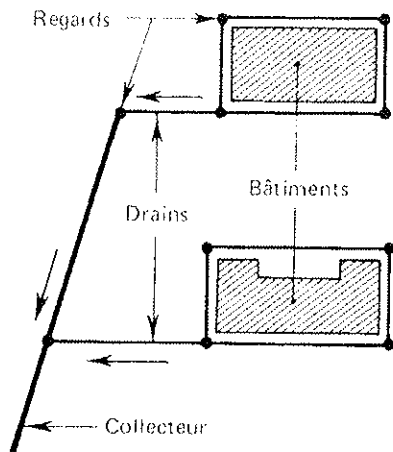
Exemple de drainage collectif d'un lotissement sur un terrain sensiblement plat
